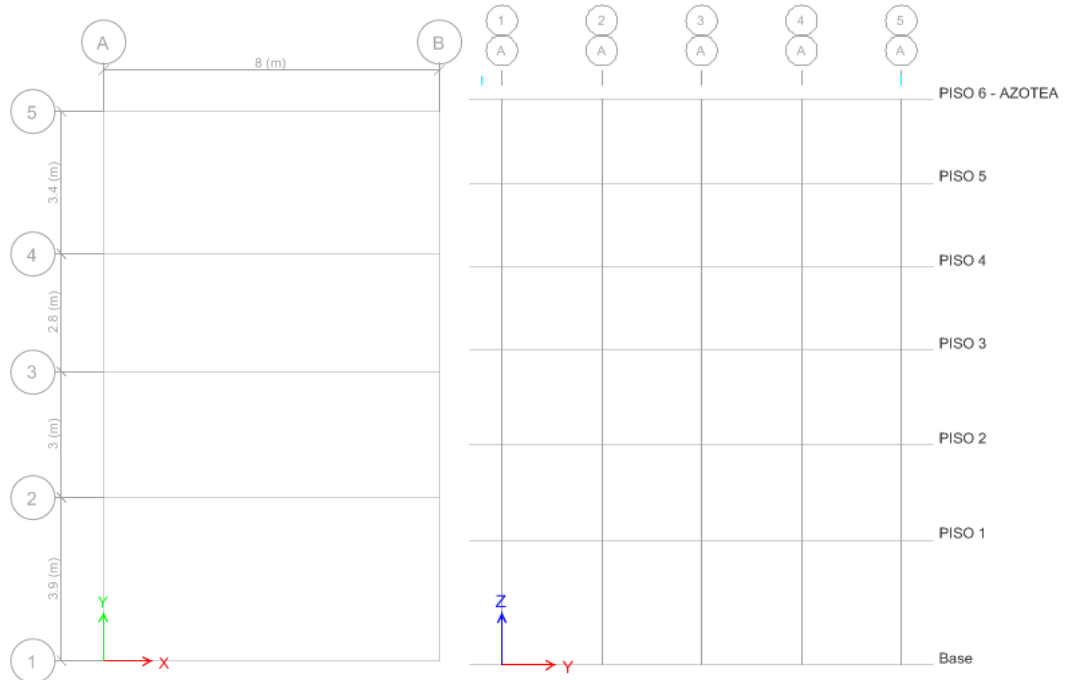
7 Vista en Planta y Elevación de la distribución de ejes.
